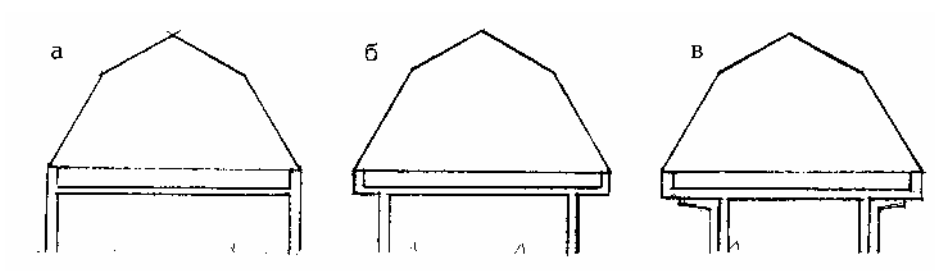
Схемы размещения мансарды: а – в створе наружных стен здания;
